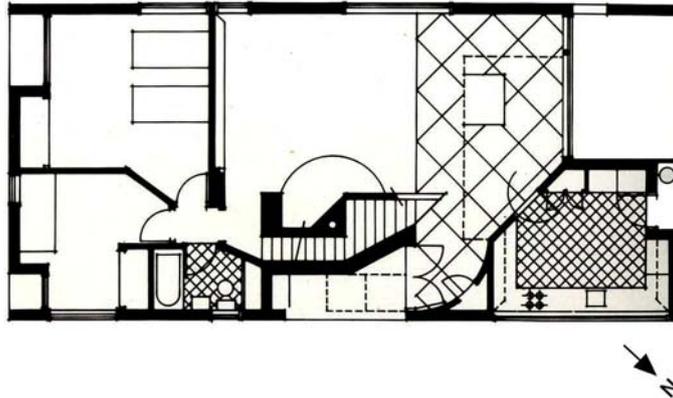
Vanna Venturi. Planta do pavimento térreo.
